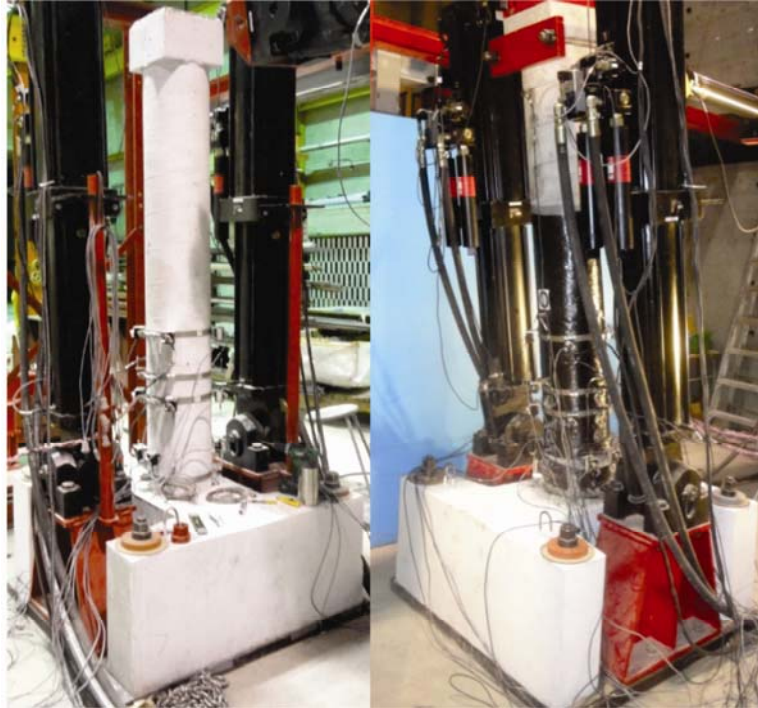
Photos du poteau de béton armé et du poteau de béton armé confiné de PRF dans le montage
